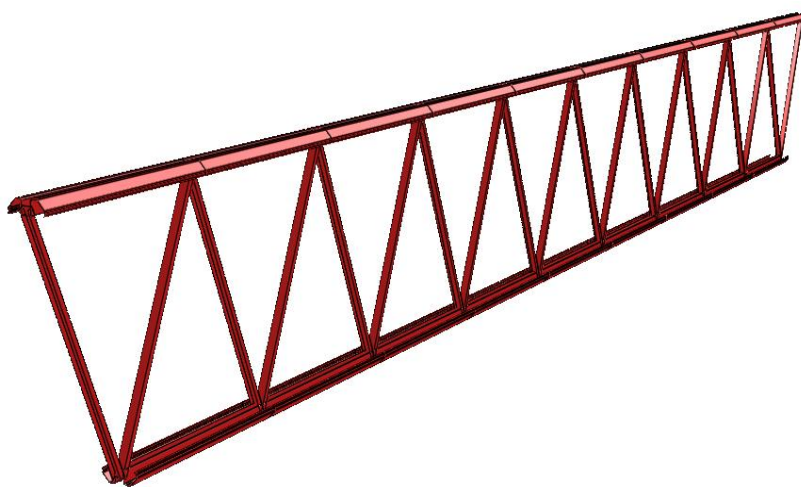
Exemplo de Viga Treliçada Tipo Joist.
